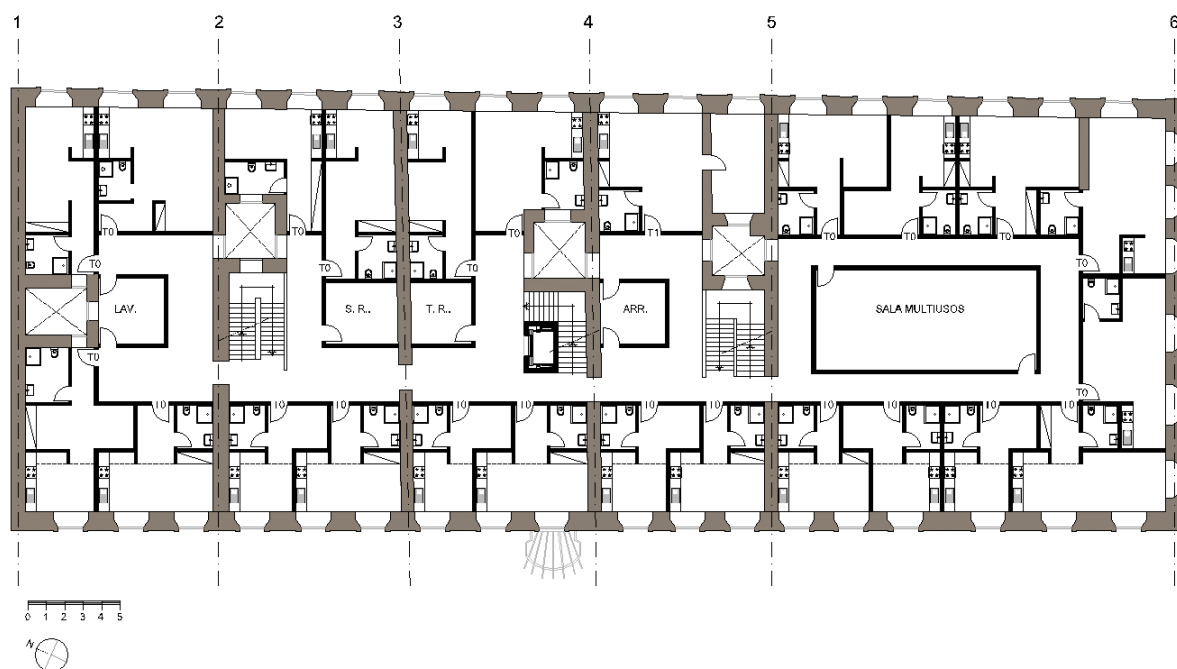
Planta dos Pisos 1, 2, 3 – (Proposta)
